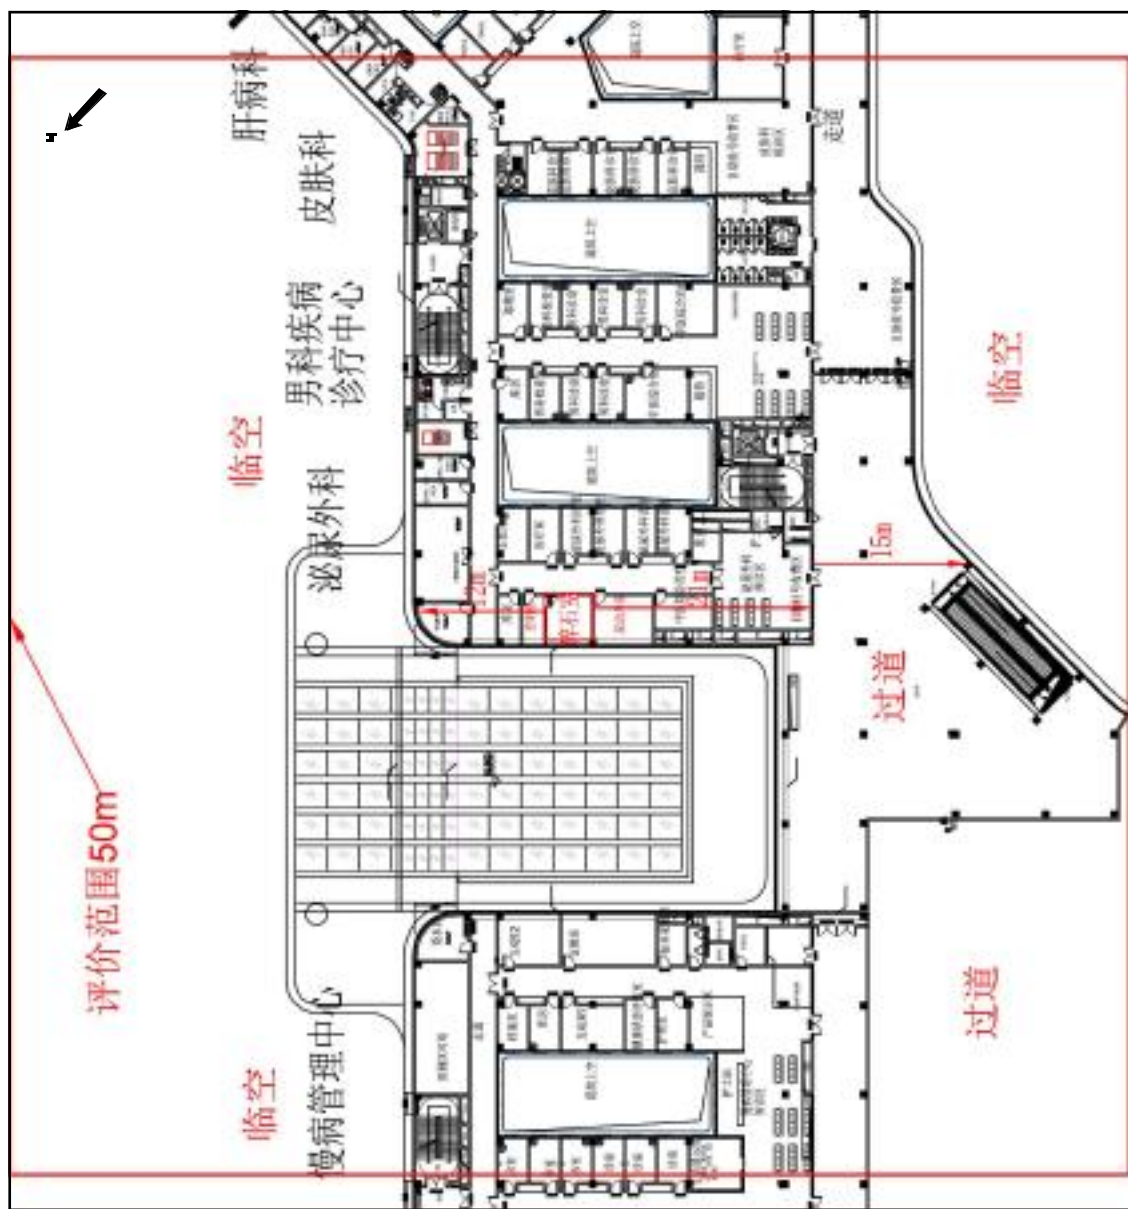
门诊楼五楼放射体肿瘤科机房 30m 范围平面图
